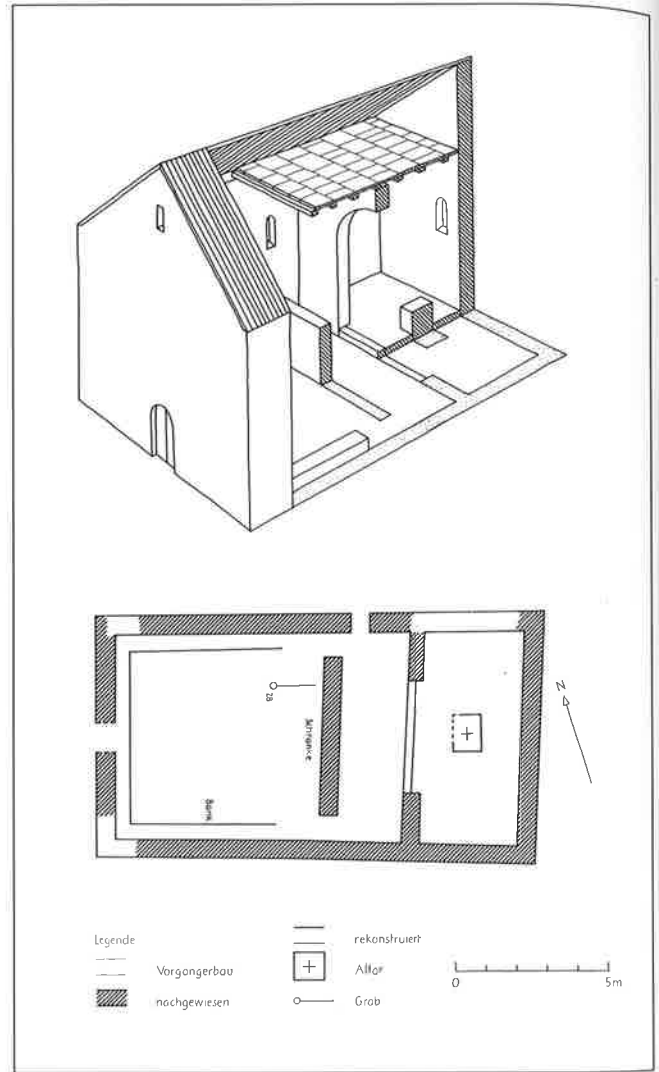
Stein am Rhein. Kirche Burg. Grundriss und Rekonstruktion der Rechteckkirche (Bau III.2). M 1:250.
